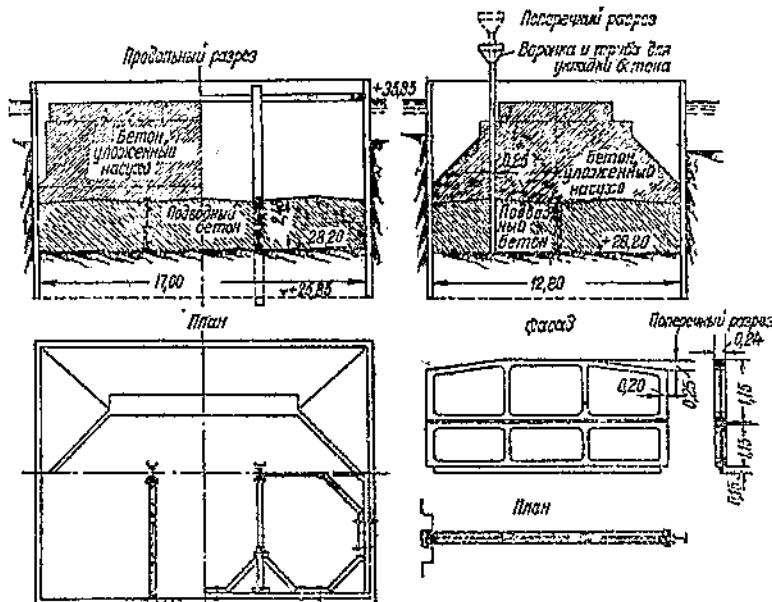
Бетонирование опор жел.-дор. моста с помощью вертикально перемещающейся трубы.
